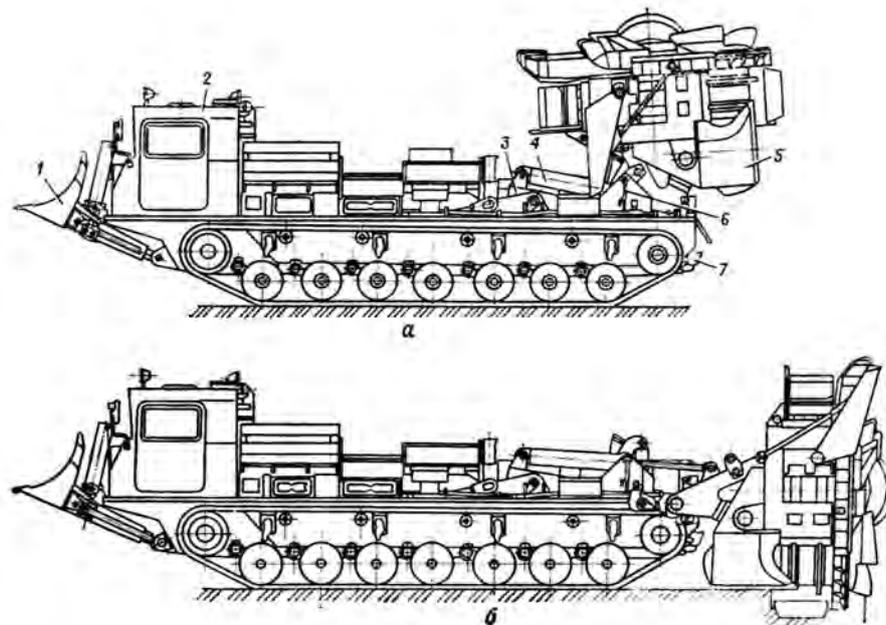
Котлованная машина МДК-3 (компоновочная схема): а — транспортное положение; б — рабочее положение; 1 — бульдозерное оборудование; 2 — базовая машина; 3 — рама; 4 — гидроцилиндр поворота; 5 — рабочий орган; 6 — фиксатор рабочего органа; 7 — рыхлительное оборудование
